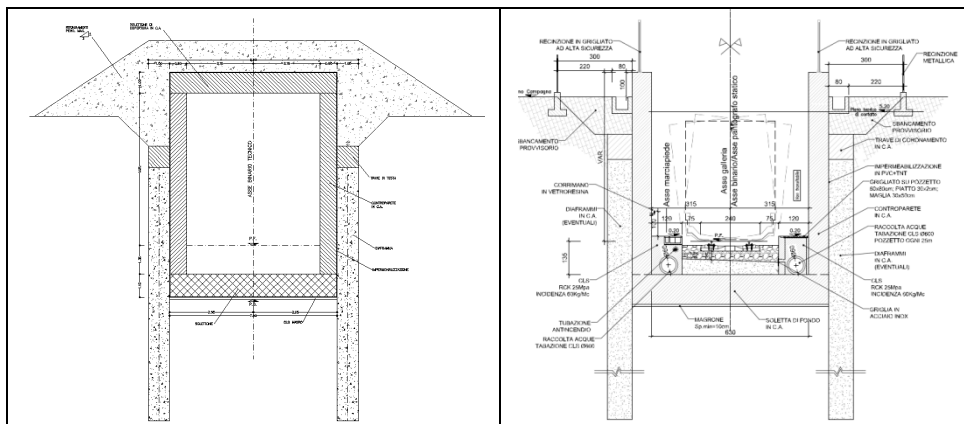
Galleria artificiale (sezione tipo “3”) e trincea monobinaria
